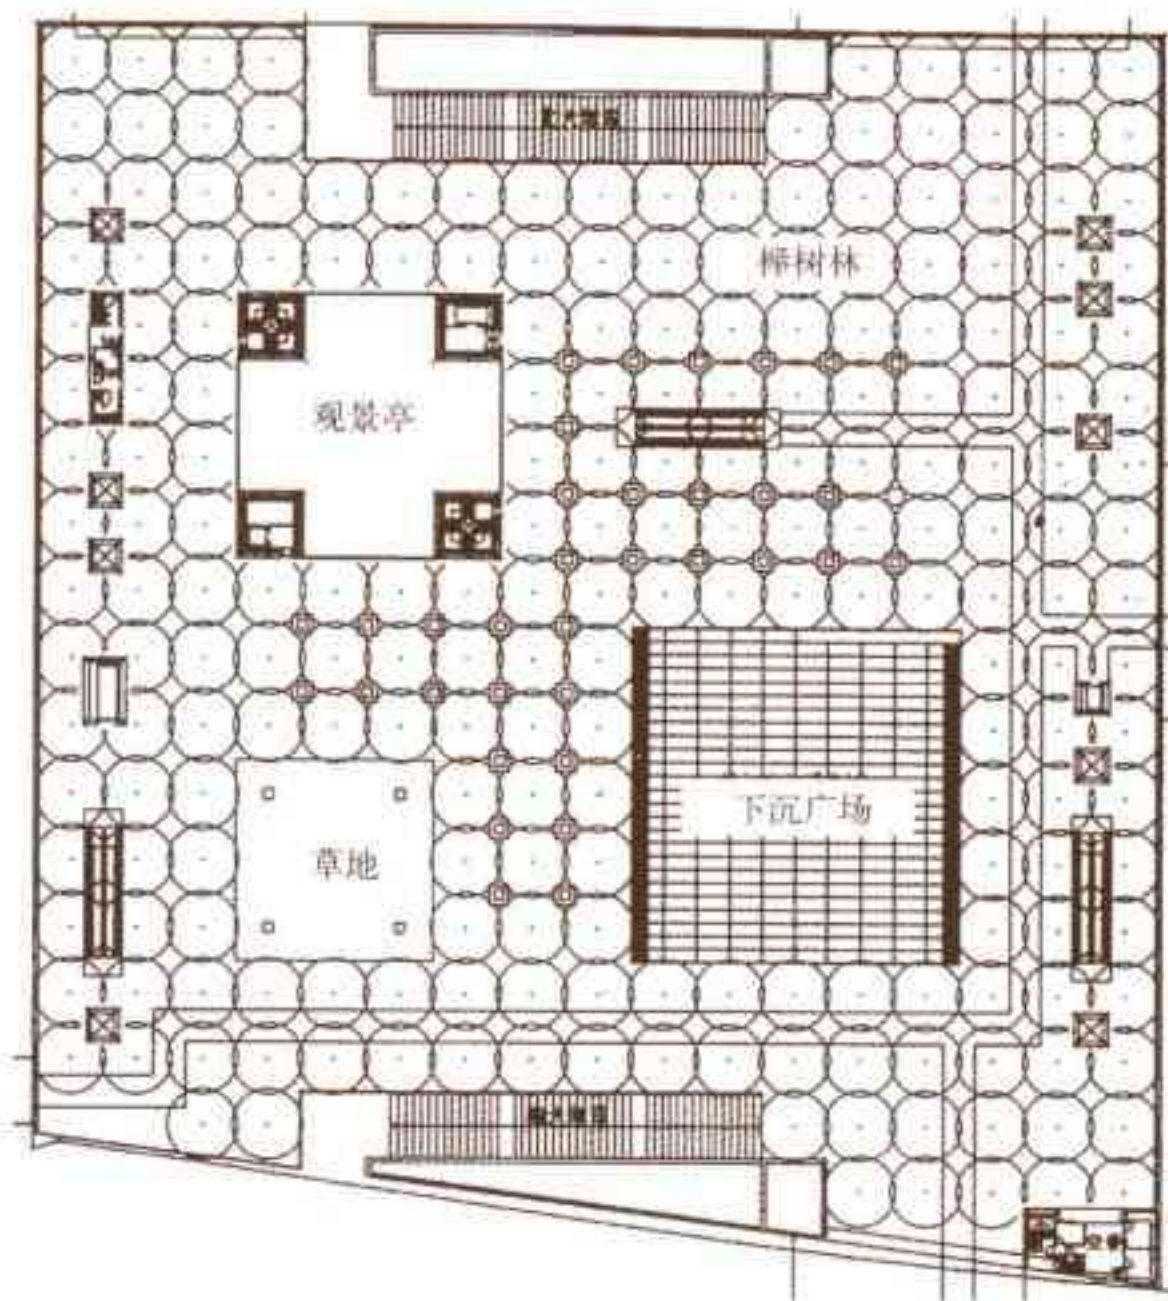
日本埼玉县空中森林广场总平面图
